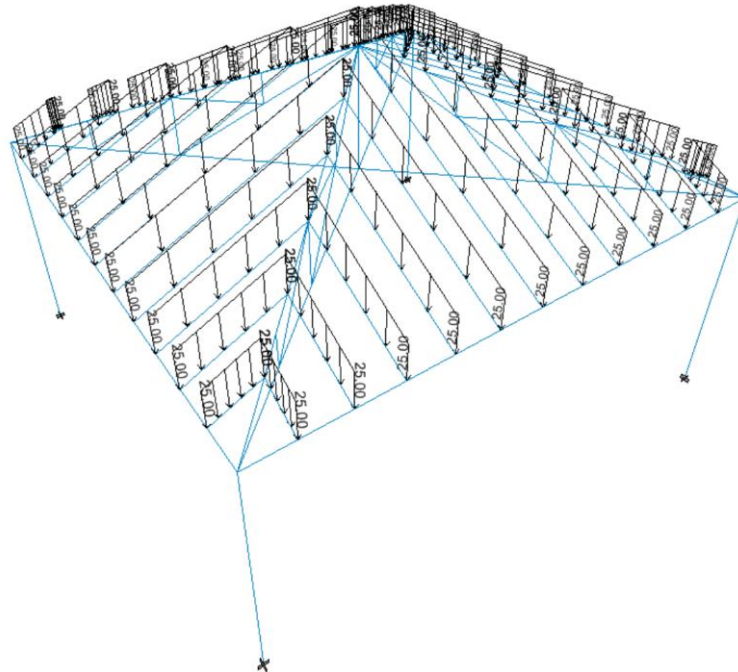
Cargas Vivas de Cubierta aplicadas al Modelo Computacional – Estructura #1
